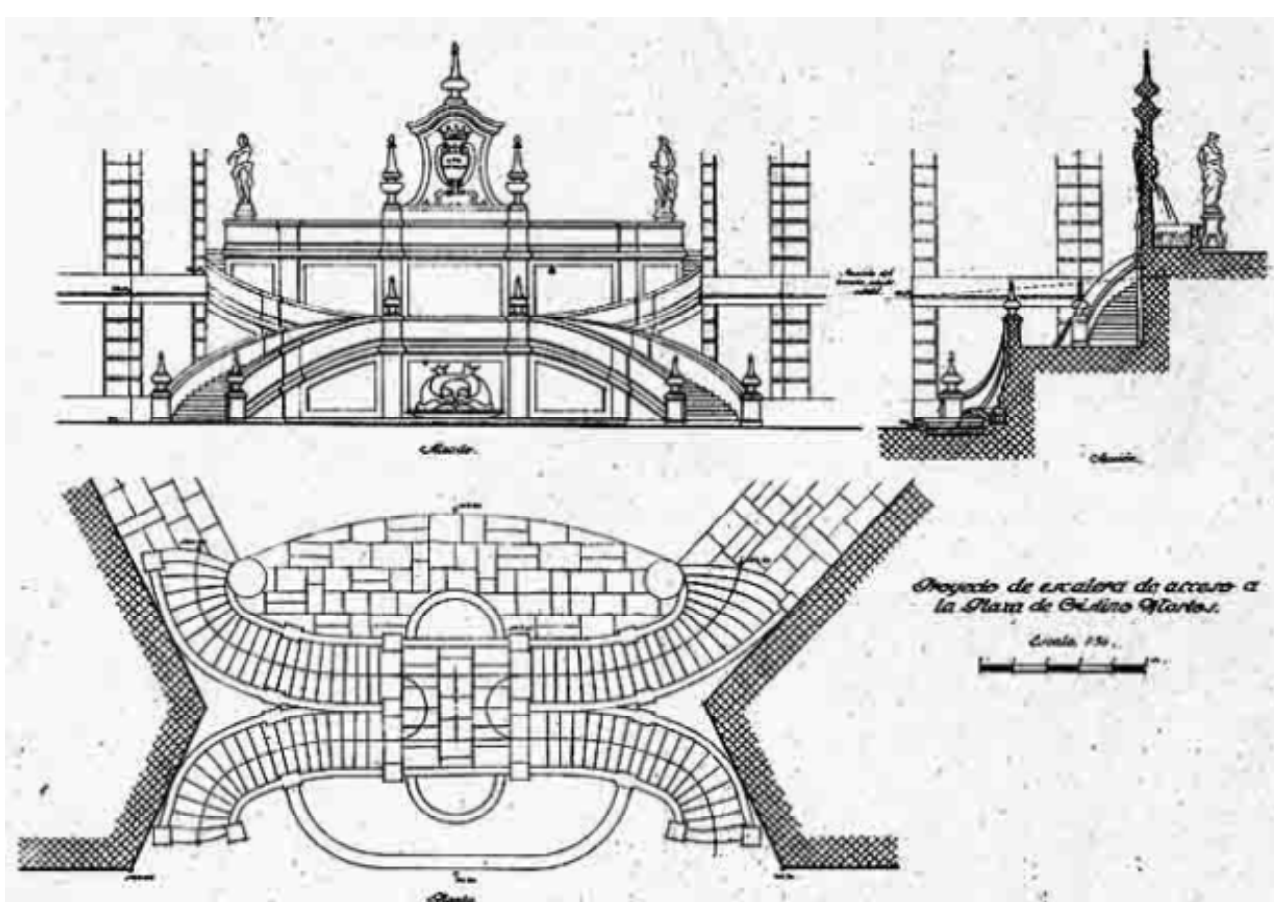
Planta y alzado de la escalera de acceso a la plaza de Cristino Martos, 1948-49. Arquitectos: Luis Pérez-Mínguez Villota y Manuel Herrero Palacios.
